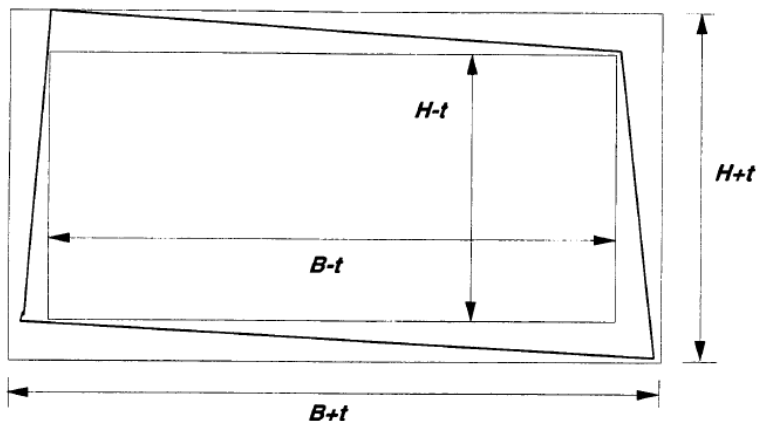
Toleranzen für die Maße von rechteckigen Scheiben
